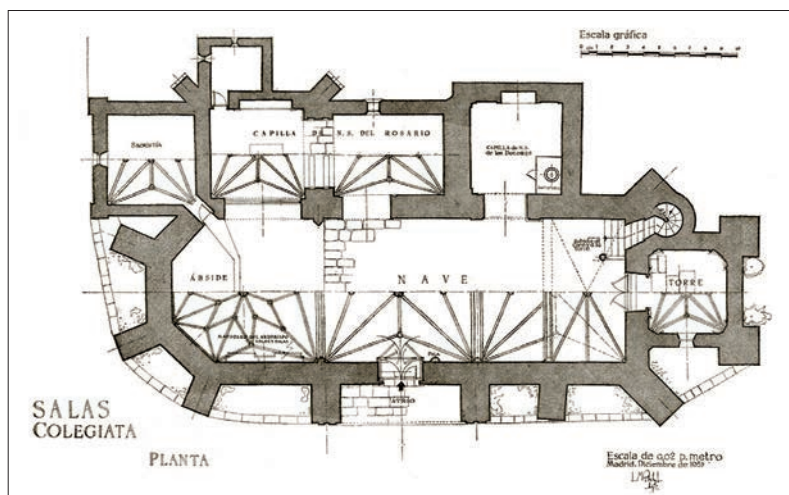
Luis Menéndez-Pidal Álvarez, planta y cubiertas del templo parroquial de Santa María de Salas (diciembre de 1957), publicada en 1958.
